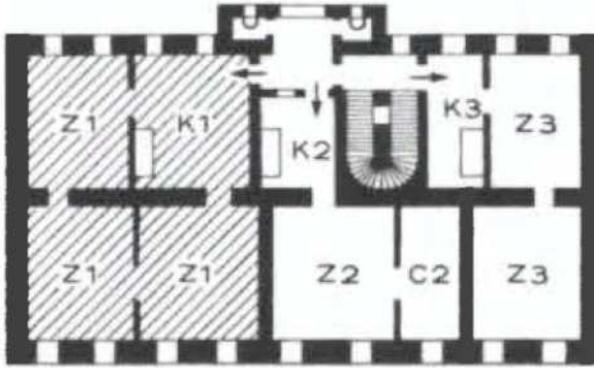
Grundriss eines frühgründerzeitlichen Straßentraktes
